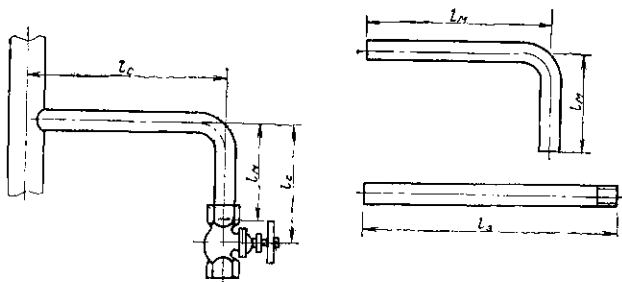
Длины заготовок из стальных труб (l_c — строительная; l_m — монтажная; l_3 — заготовительная)
